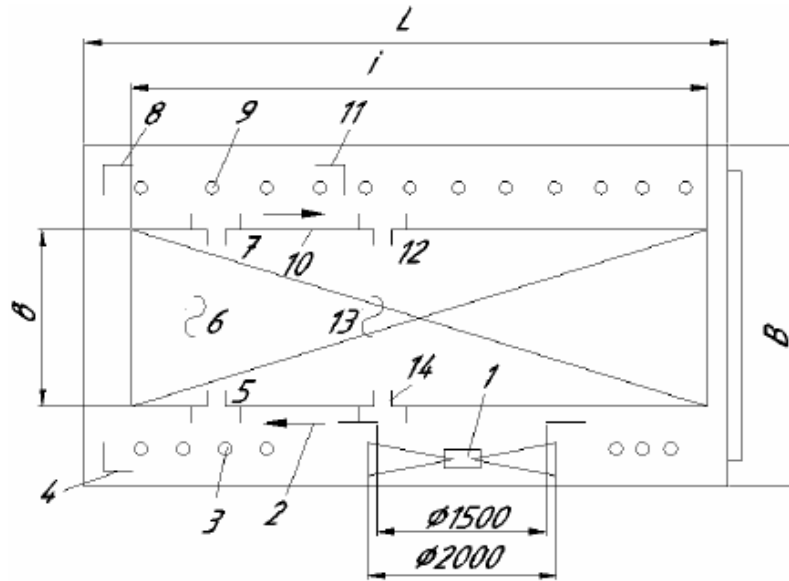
Расчетная схема сушильной камеры с боковым расположением вентилятора:
